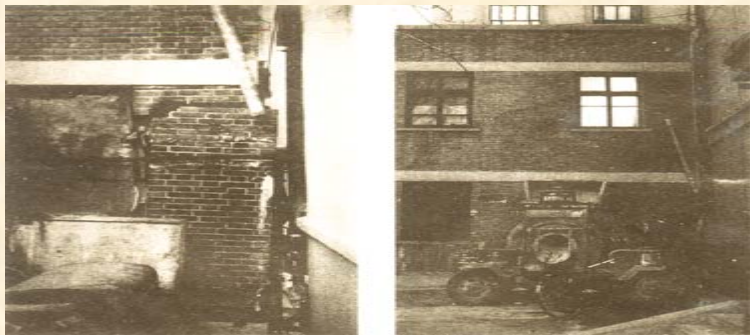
办公楼一层、二层墙体开裂情况
